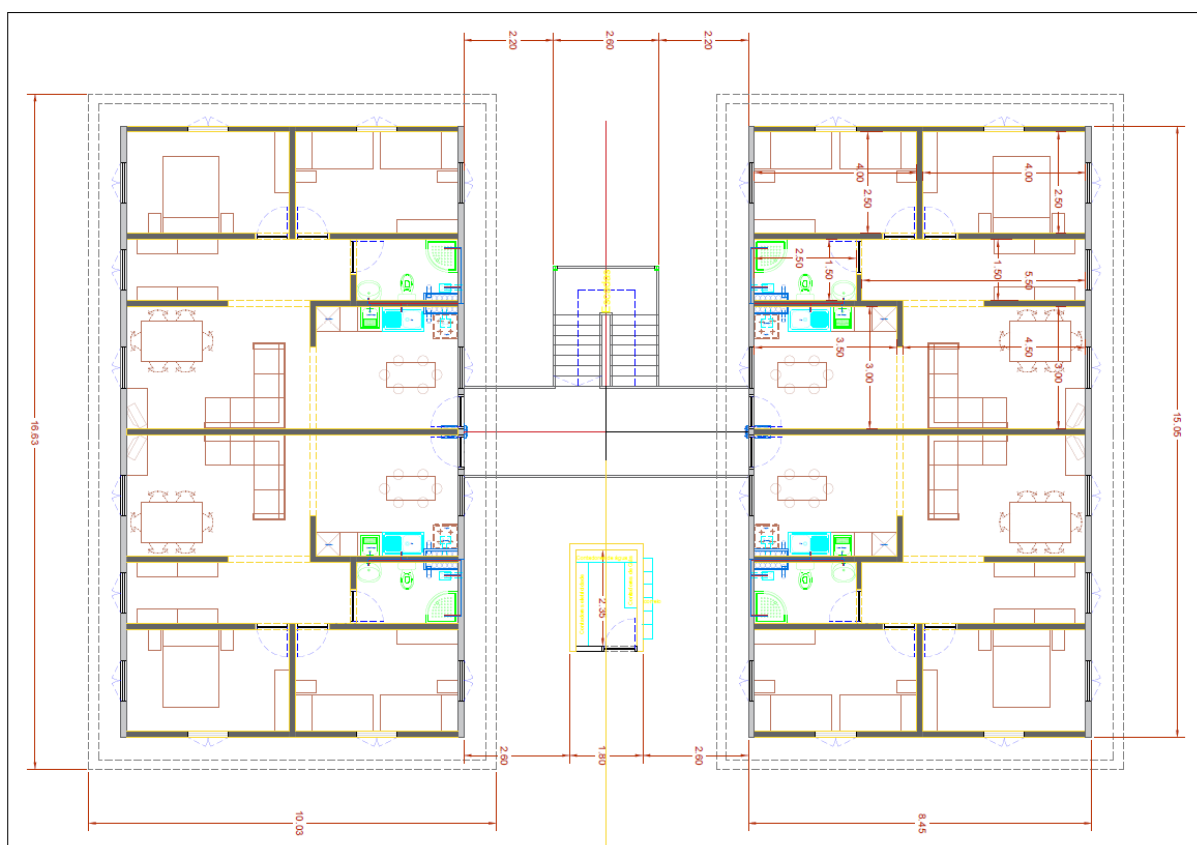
Planta do piso térreo (maior pormenor no anexo A).
